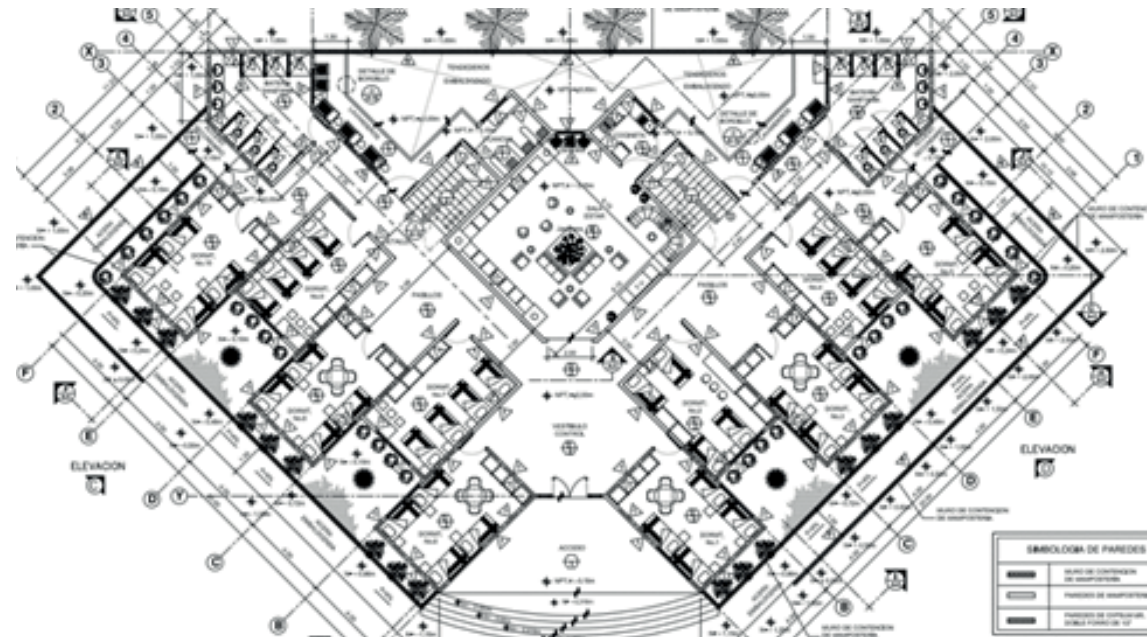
Fuente: Propia. Planta arquitectónica el Edificio.
